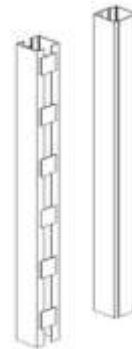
Alzado de las 2 opciones de cierre de perfiles
